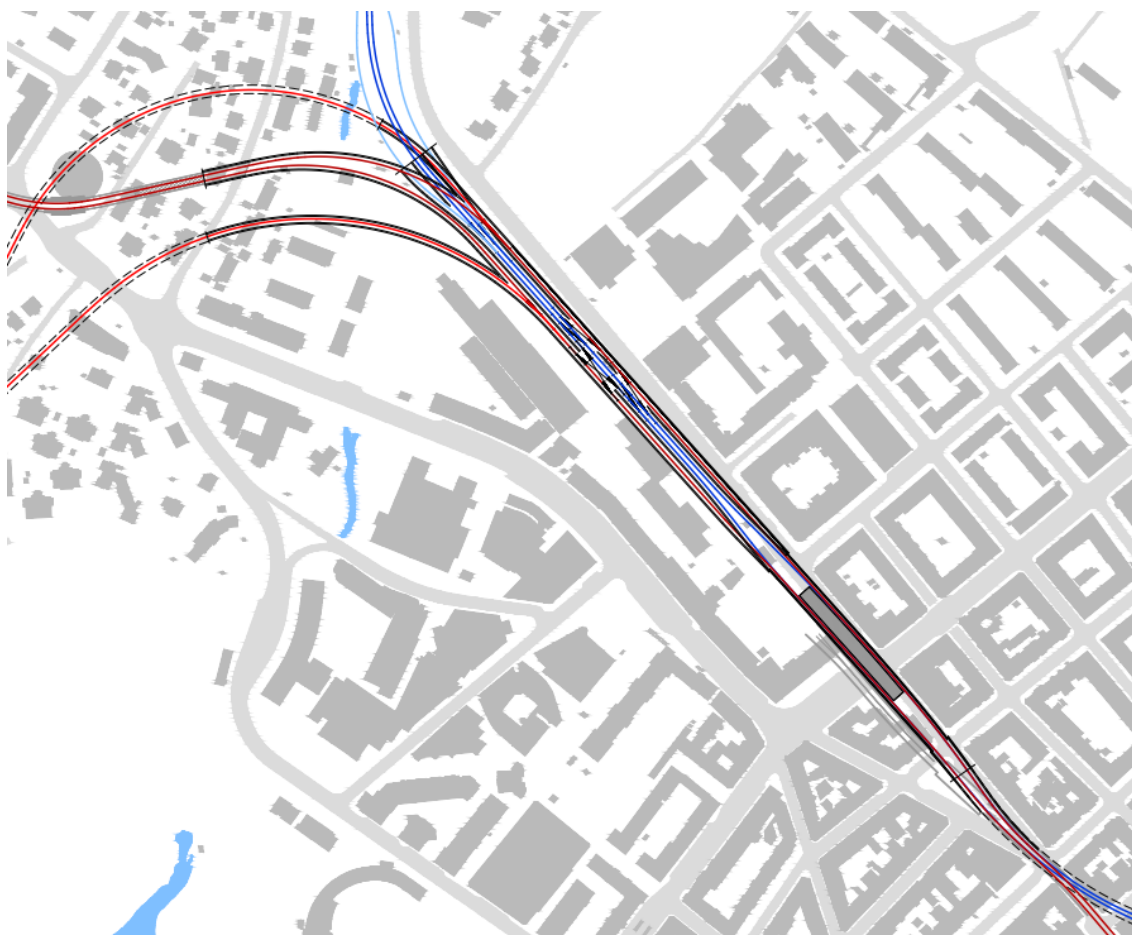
Løsmassekulvert Kuba – Olaf Ryes plass – Sofienbergparken.
